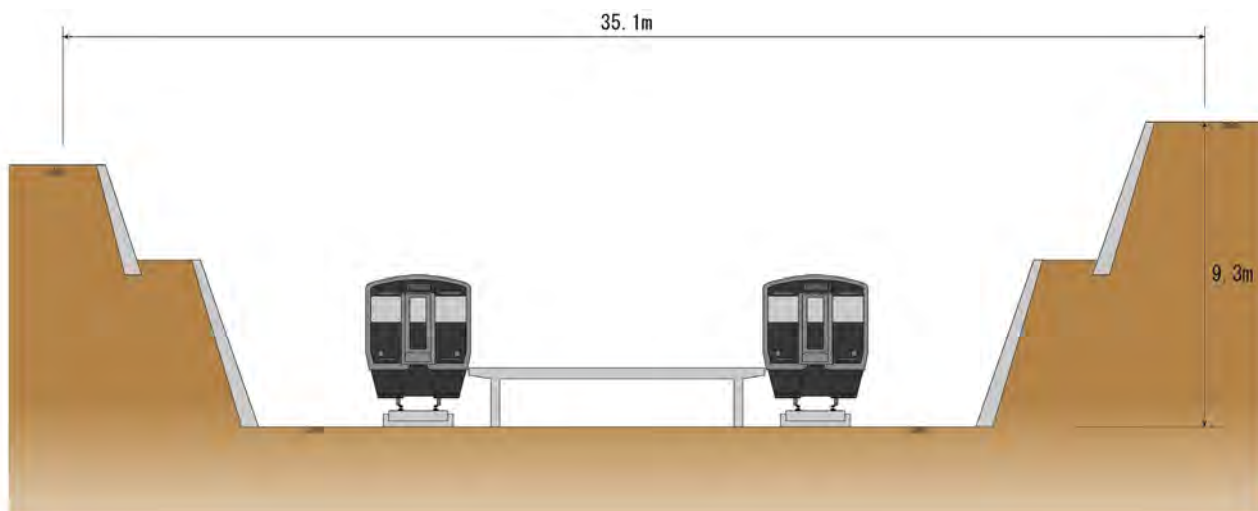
(5) 計画路線の標準横断面図 (断面⑤：地表式)
